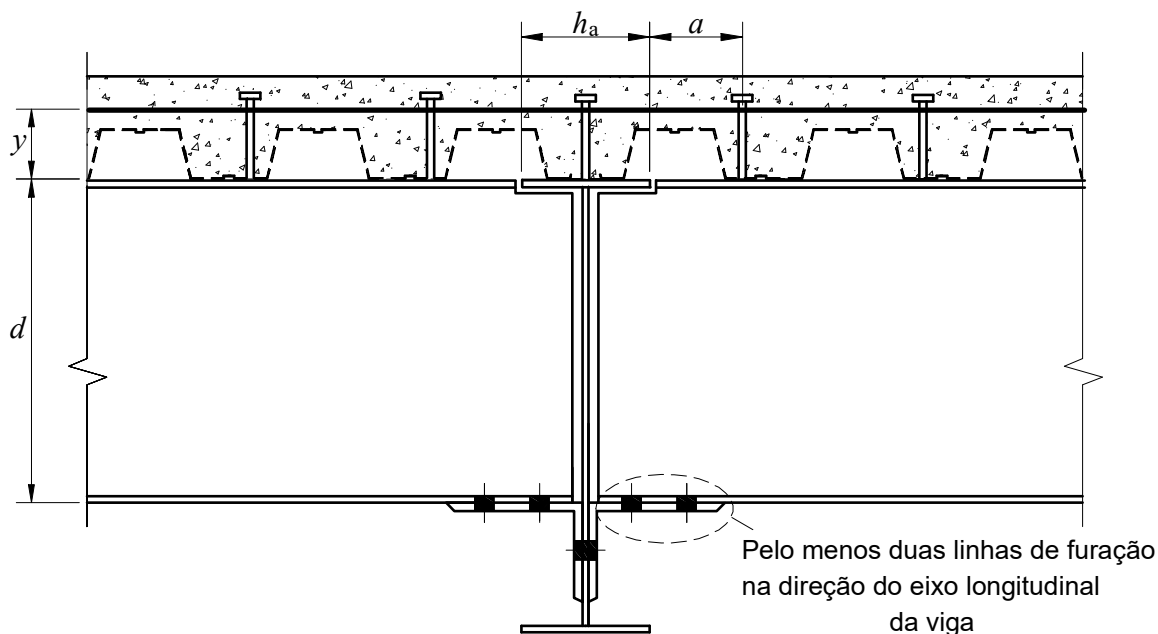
Ligação mista com cantoneira parafusada na mesa inferior da viga apoiada
